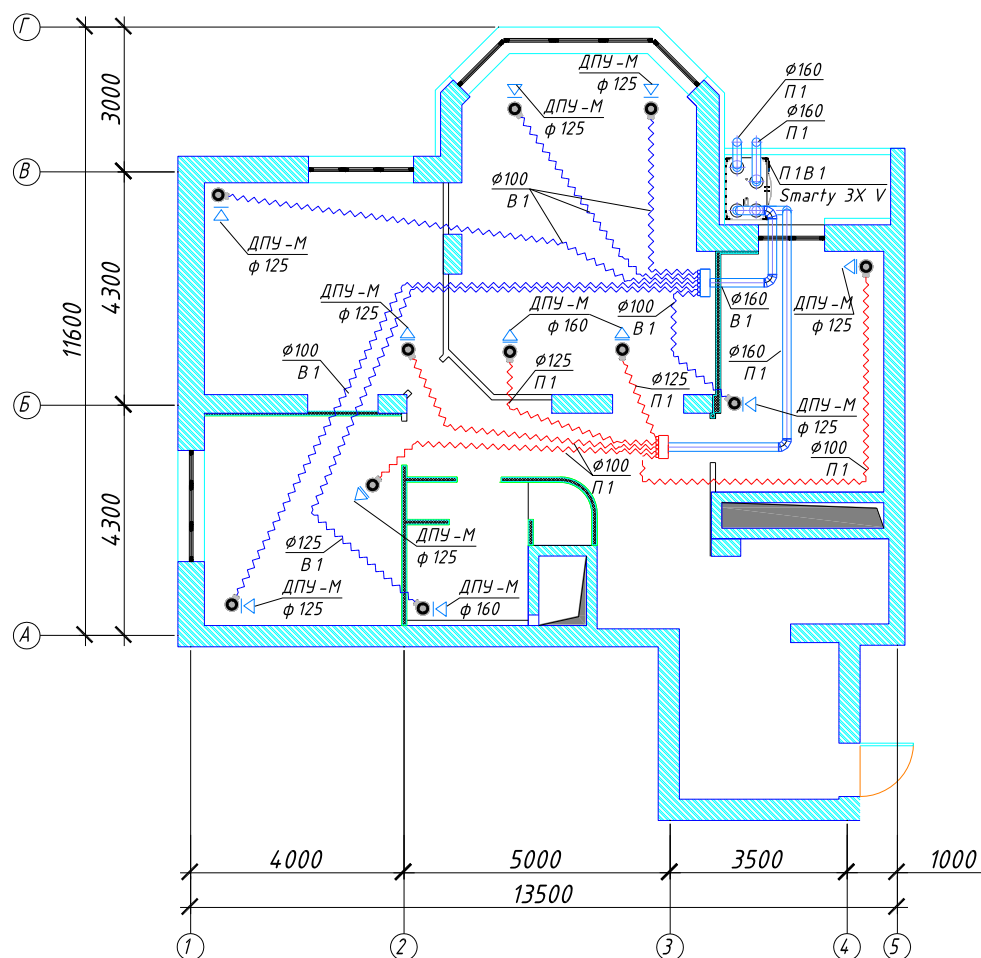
План трёхкомнатной квартиры в жилом здании с компоновкой вентиляционного оборудования по схеме приточно-вытяжной вентиляции по Варианту № 1 с теплоутилизатором в приточно-вытяжной системе П1В1
